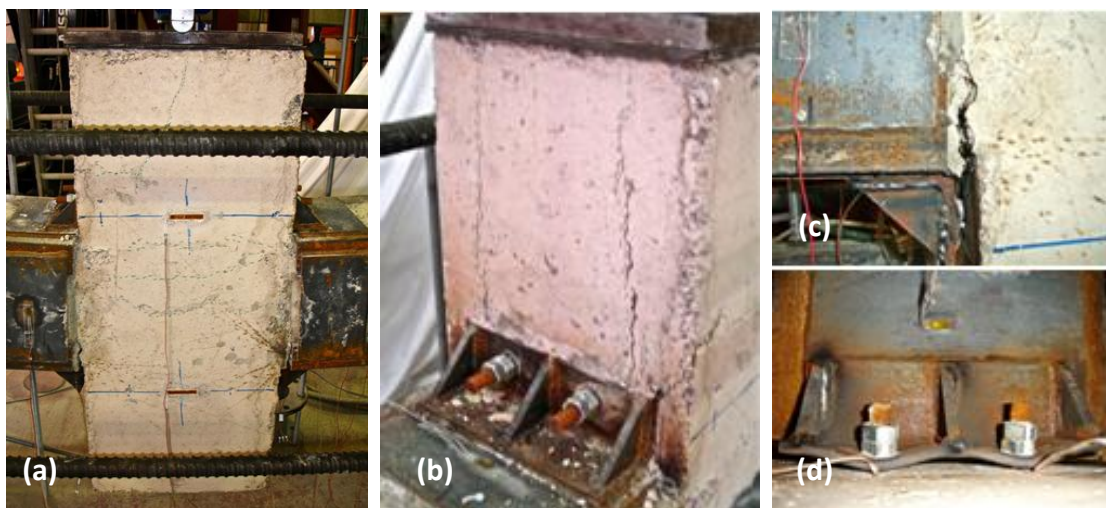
Rotura de probetas tipo B (Garzón-Roca et al., 2011a). a) foto frontal del nudo. b) fisuras de compresión del nudo en zona superior, con penetración del capitel en el hormigón c) fisura de tracción con despegue de capitel debido a su deformación. d) deformación de capitel en zona inferior traccionada.
